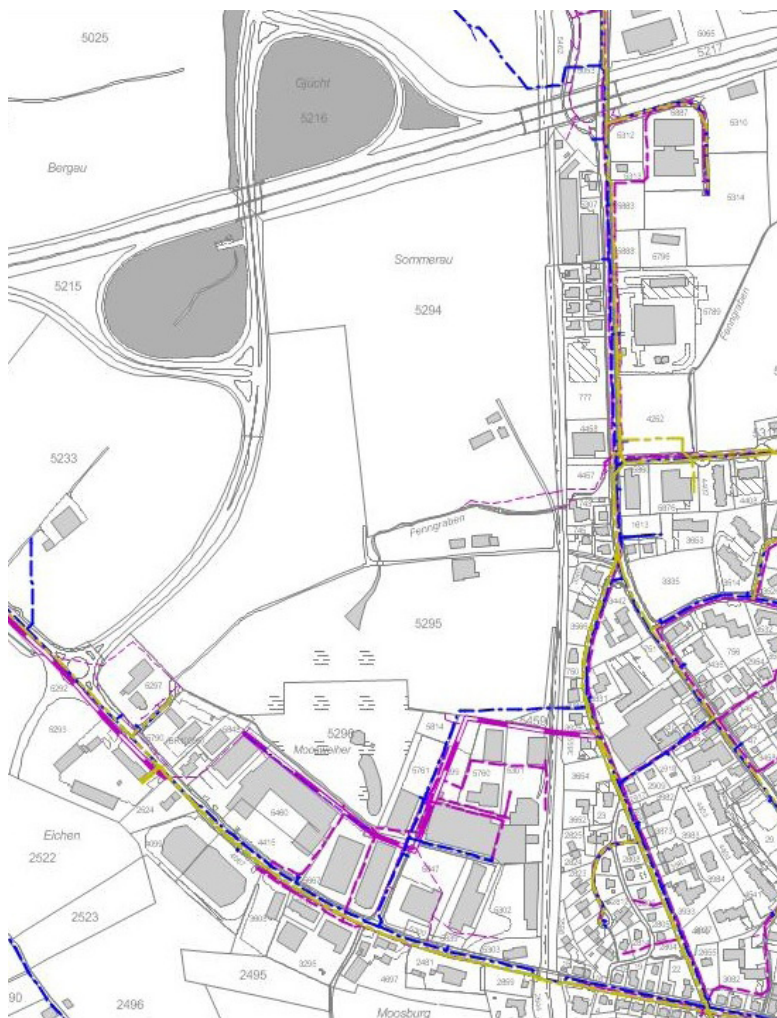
Bestehende Werkleitungen Sommerau Nord
